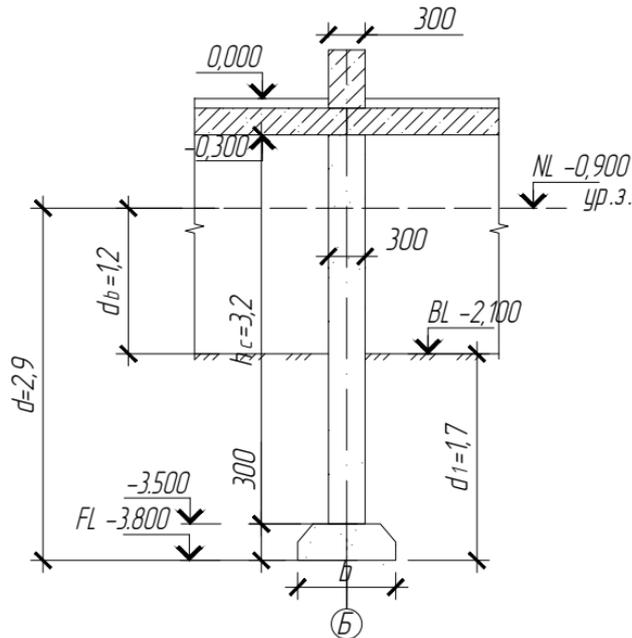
Расчетная схема к определению ширины подошвы фундамента
